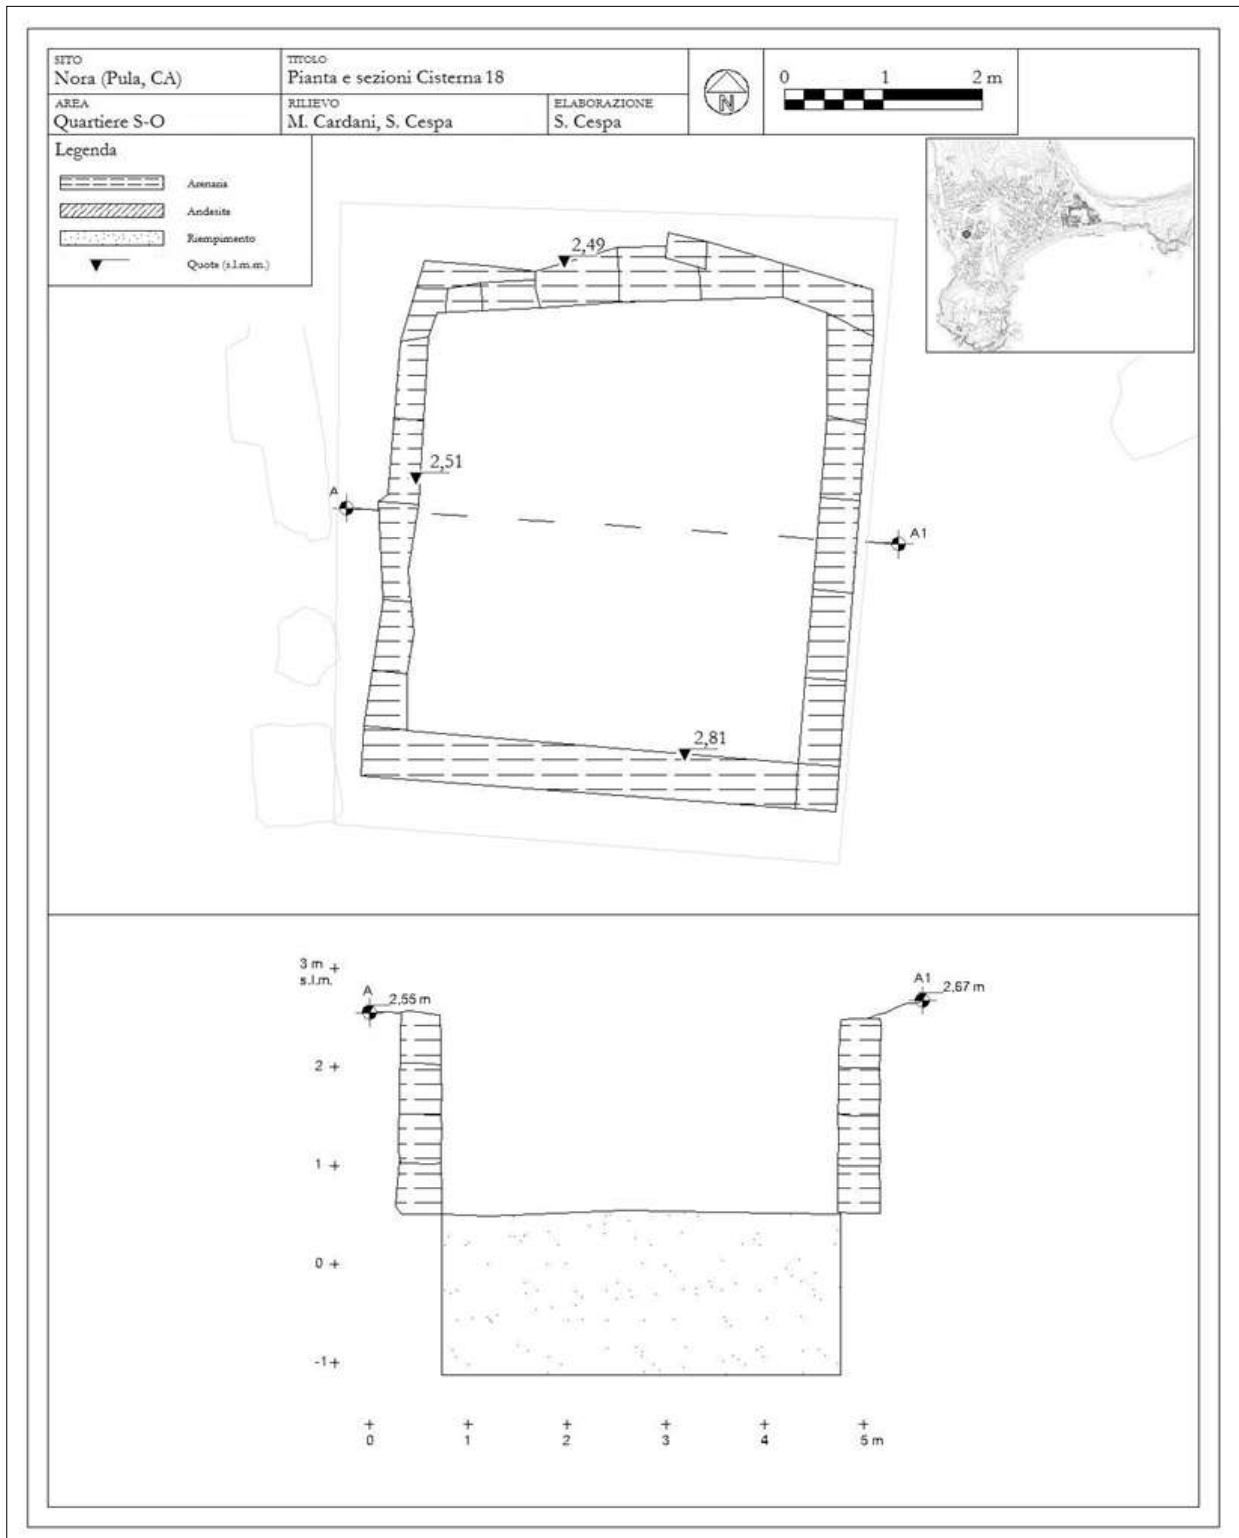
Pianta e sezione della cisterna 18 (elaborazione dell'autore).
